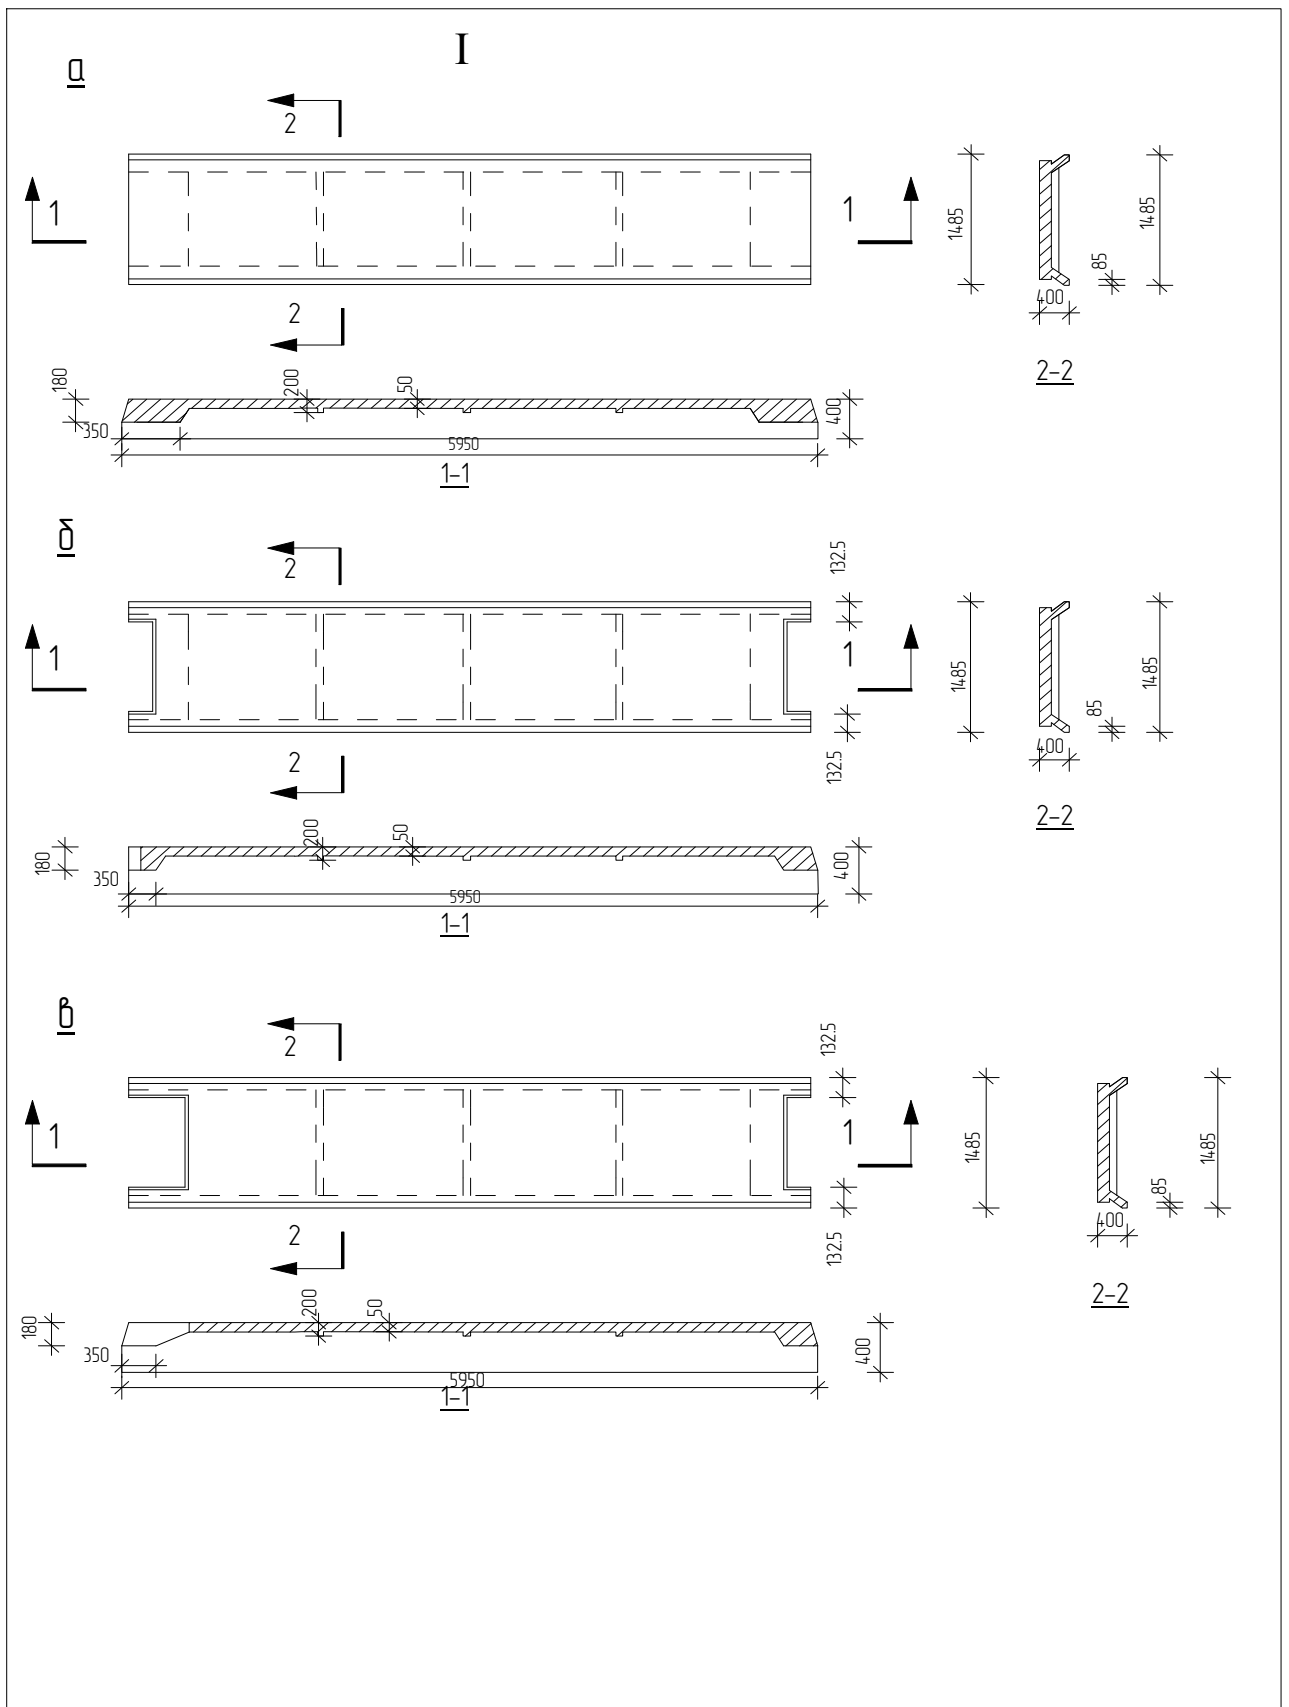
Ребриста плита перекриття, а – рядова плита перекриття;
